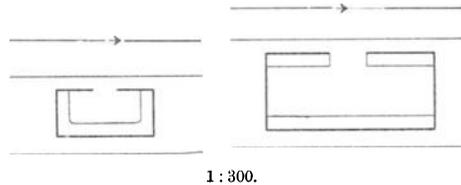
u. 194. Grundrisse von Wartehallen.
